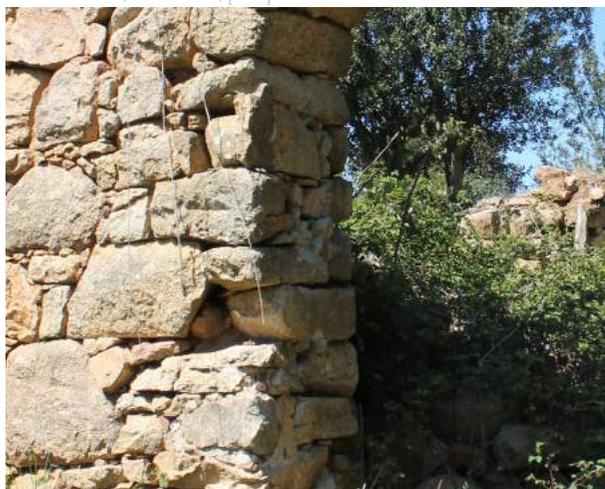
AA Particolare dell'Apertura con Arco Lapideo. Si nota lo stipite ammassato alla muratura. Porta, Edificio 3, prospetto esterno. Foto dell'Autore.
